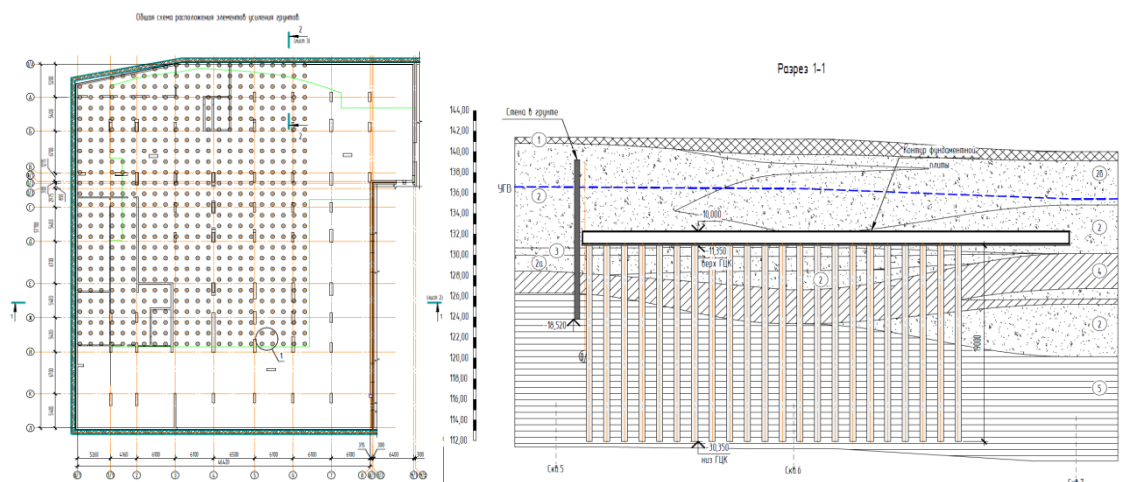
Усиление основания фундаментов комбинированными грунтобетонными сваями: а – план; б – разрез 1-1
